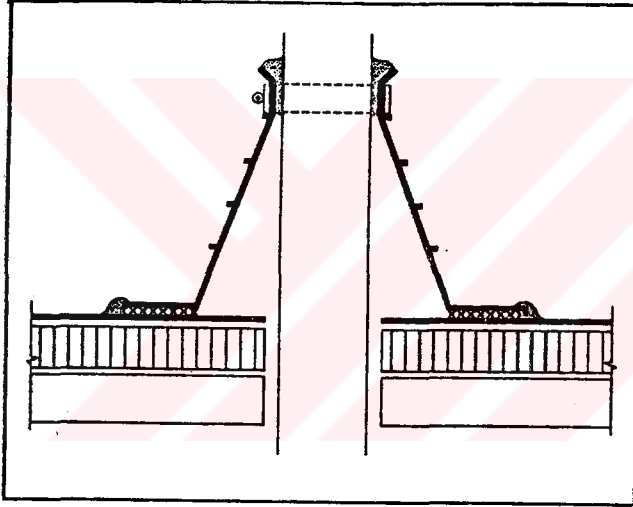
e. Yüksek ve alçak blok arasındaki dilatasyon detayı
